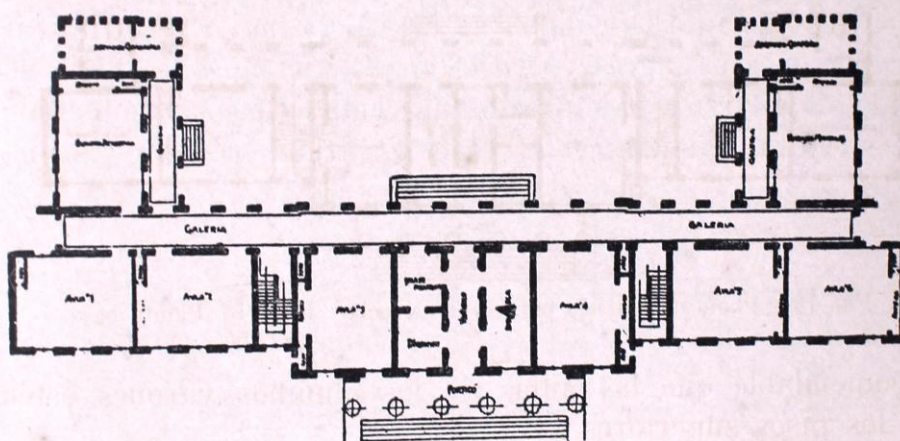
Plano de edificio para centro escolar. Tipo A o provincial. Planta baja.
